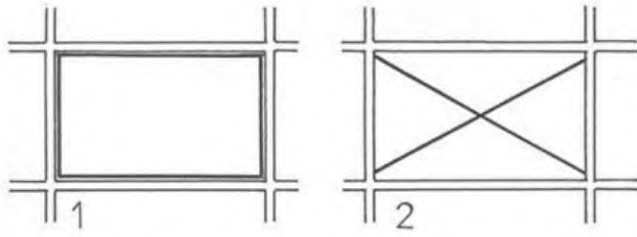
(1) Contreventement par anneau de remplissage plein;
